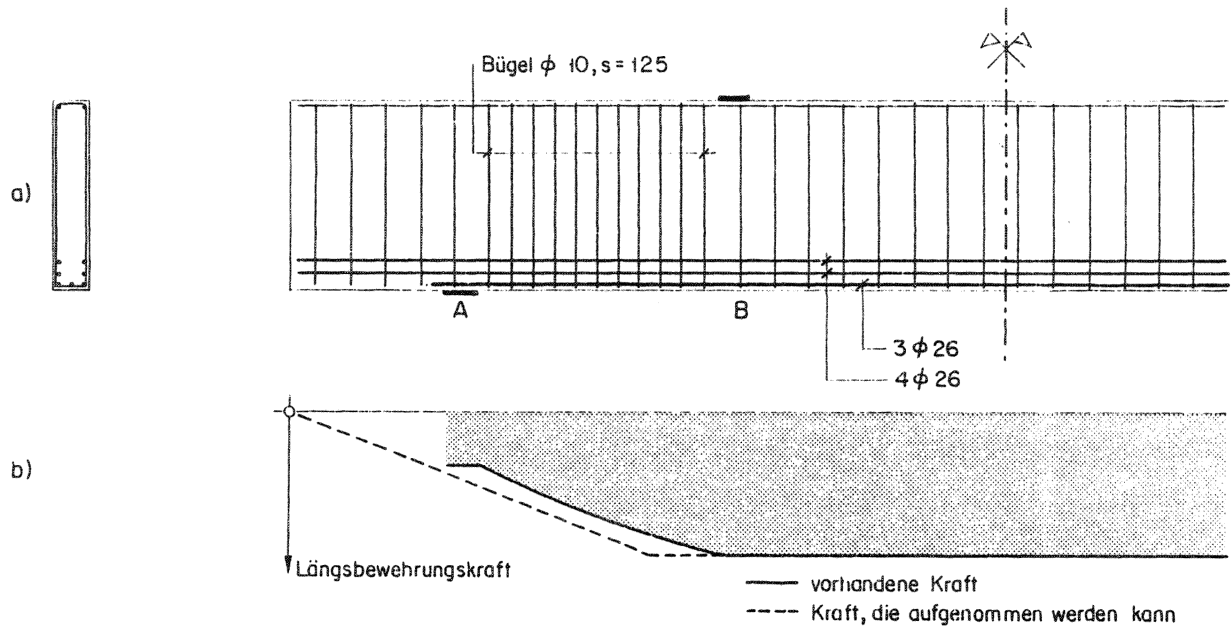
Bewehrungsskizze und Verlauf der Längsbewehrungskraft
